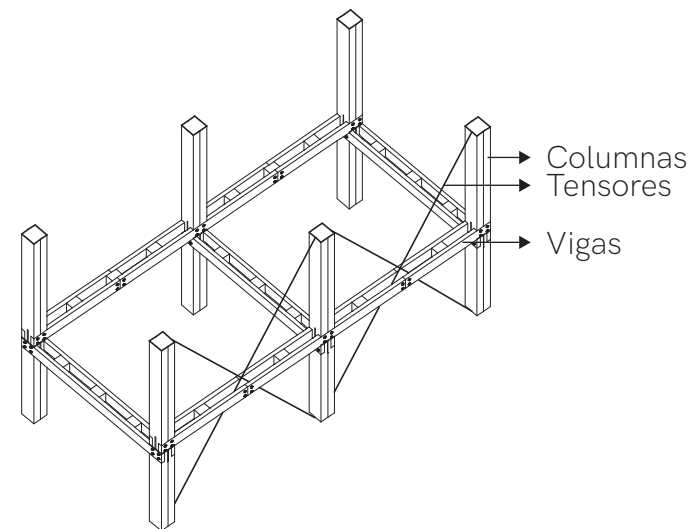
Esquema de cimentación. Fuente: Elaboración propia.
